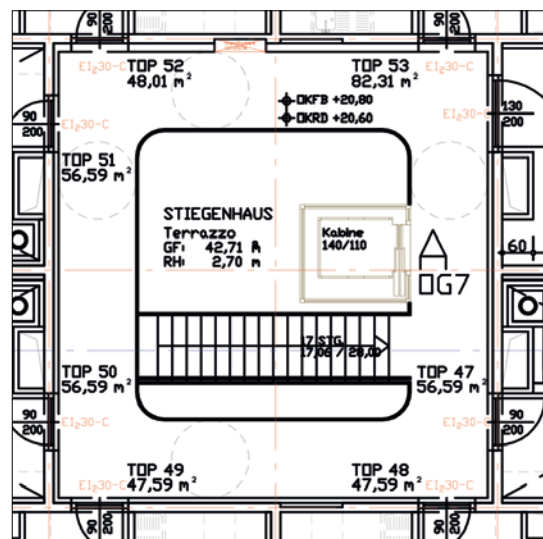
Grundriss des druckbelüfteten Stiegenhauses
